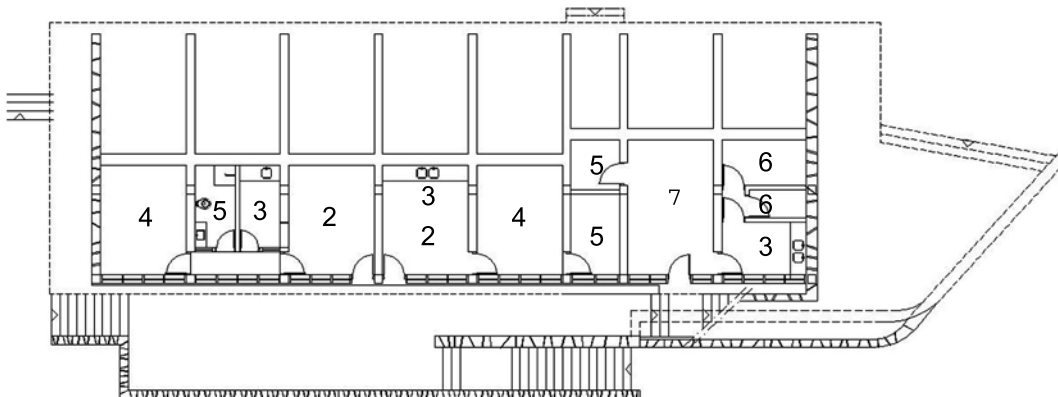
Pousada Pedra Grande - Planta de Cobertura
